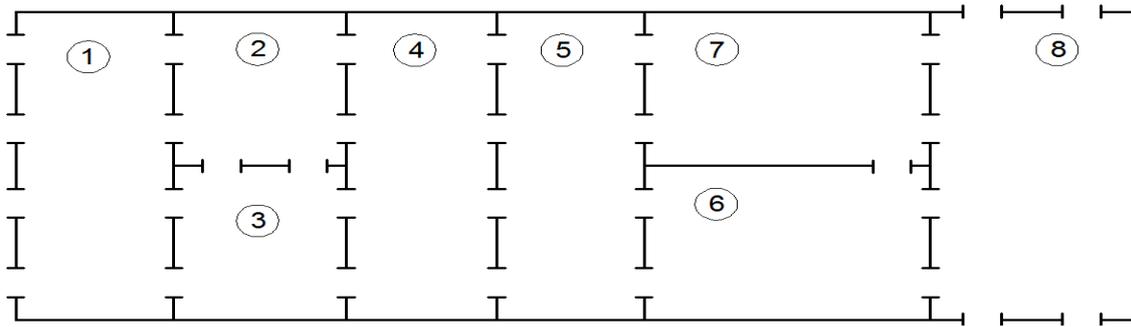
Схематичное расположение отделений заготовительного корпуса завода приборостроения при блокировании трех корпусов в различных направлениях
